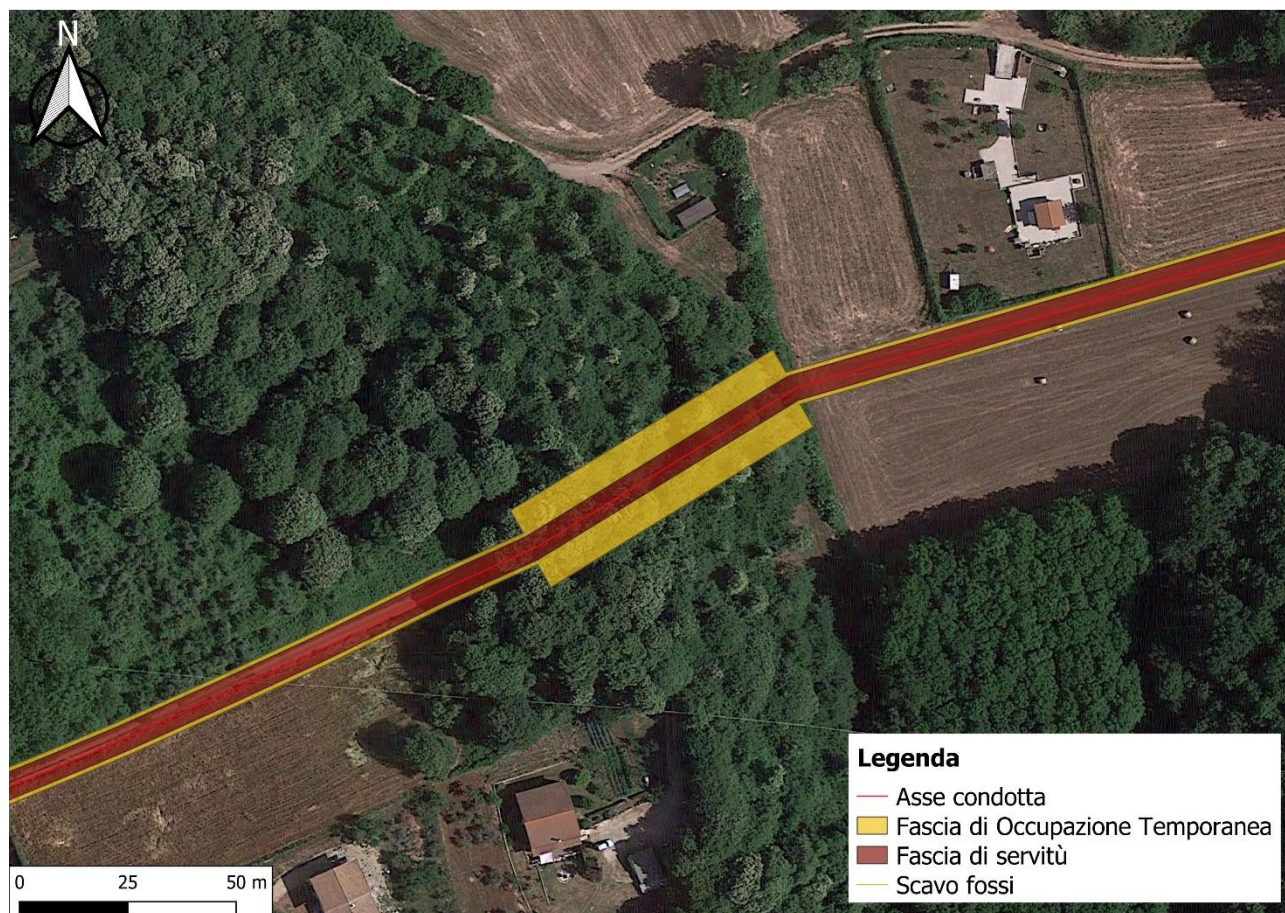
Planimetria attività di lavoro su Valle dei Pischeri
